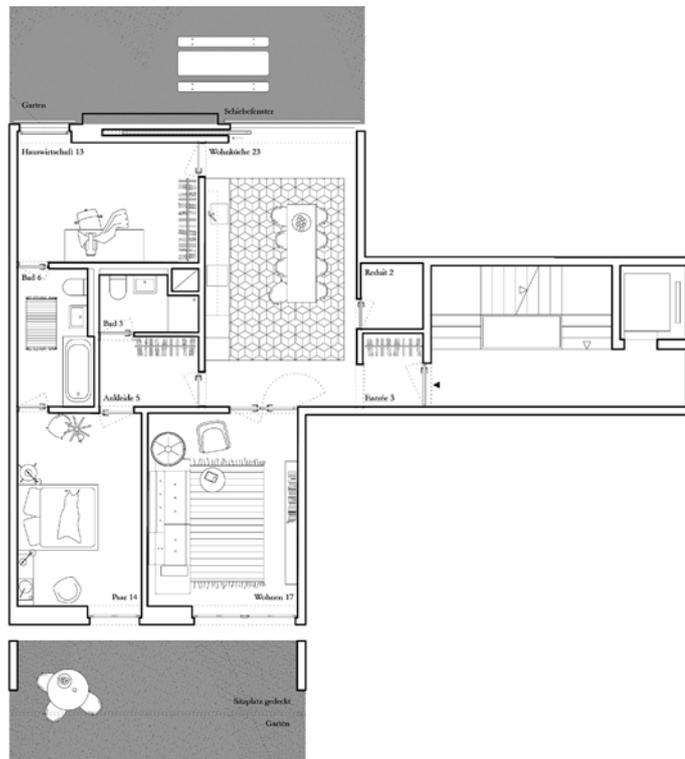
Wohnungsgrundriss 3.5 Zimmer - Whg.
